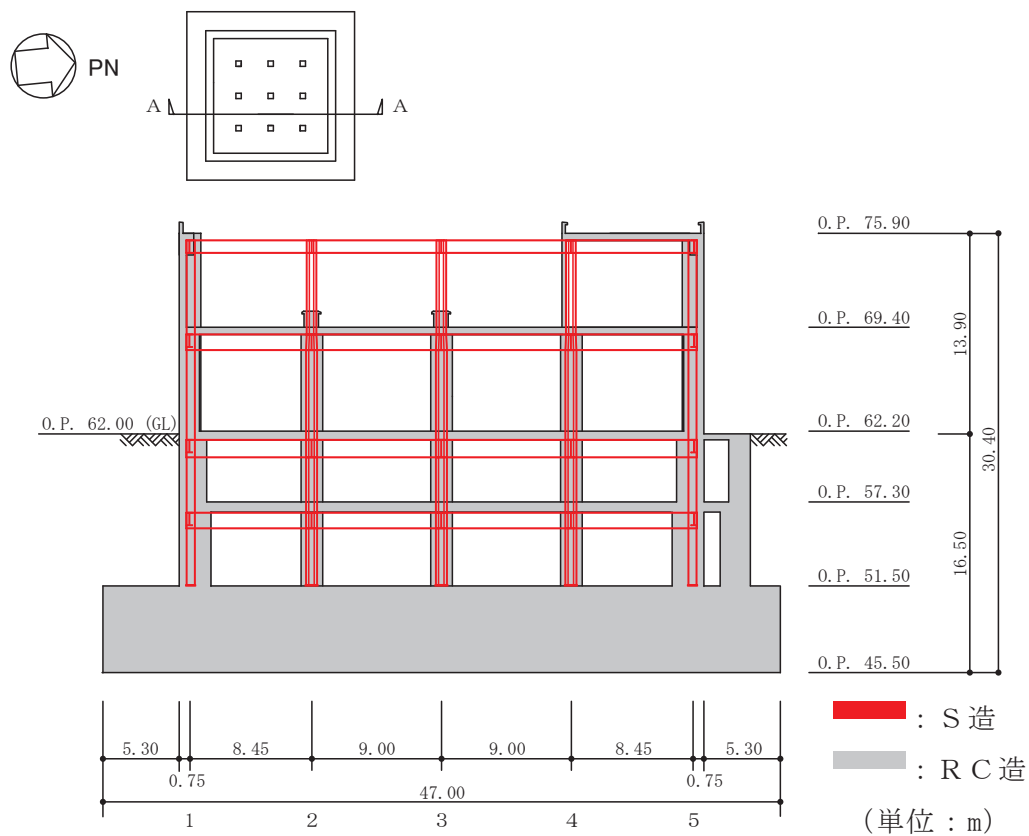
(1) 緊急時対策建屋の概略断面図 (A-A 断面, NS 方向)
